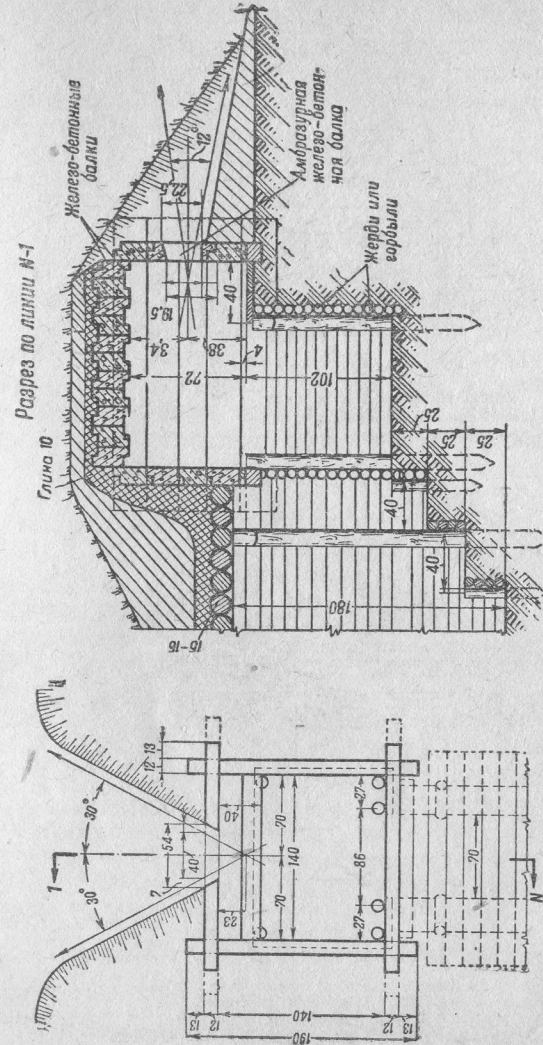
Пулемётное гнездо из железобетонных блоков.
